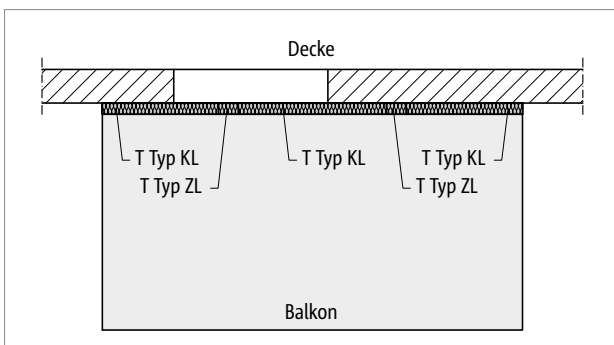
Schöck Isokorb® T Typ ZL, KL: Balkon frei ausragend
